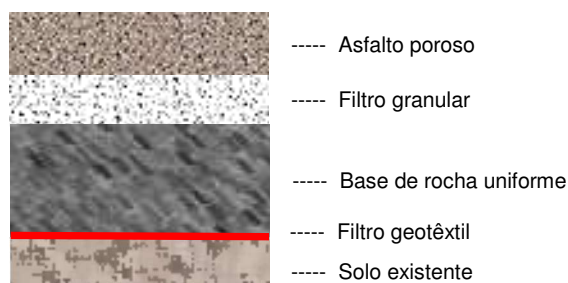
Estrutura de pavimento (revestimento em betão ou asfalto poroso) (A. Costa, 2010).
